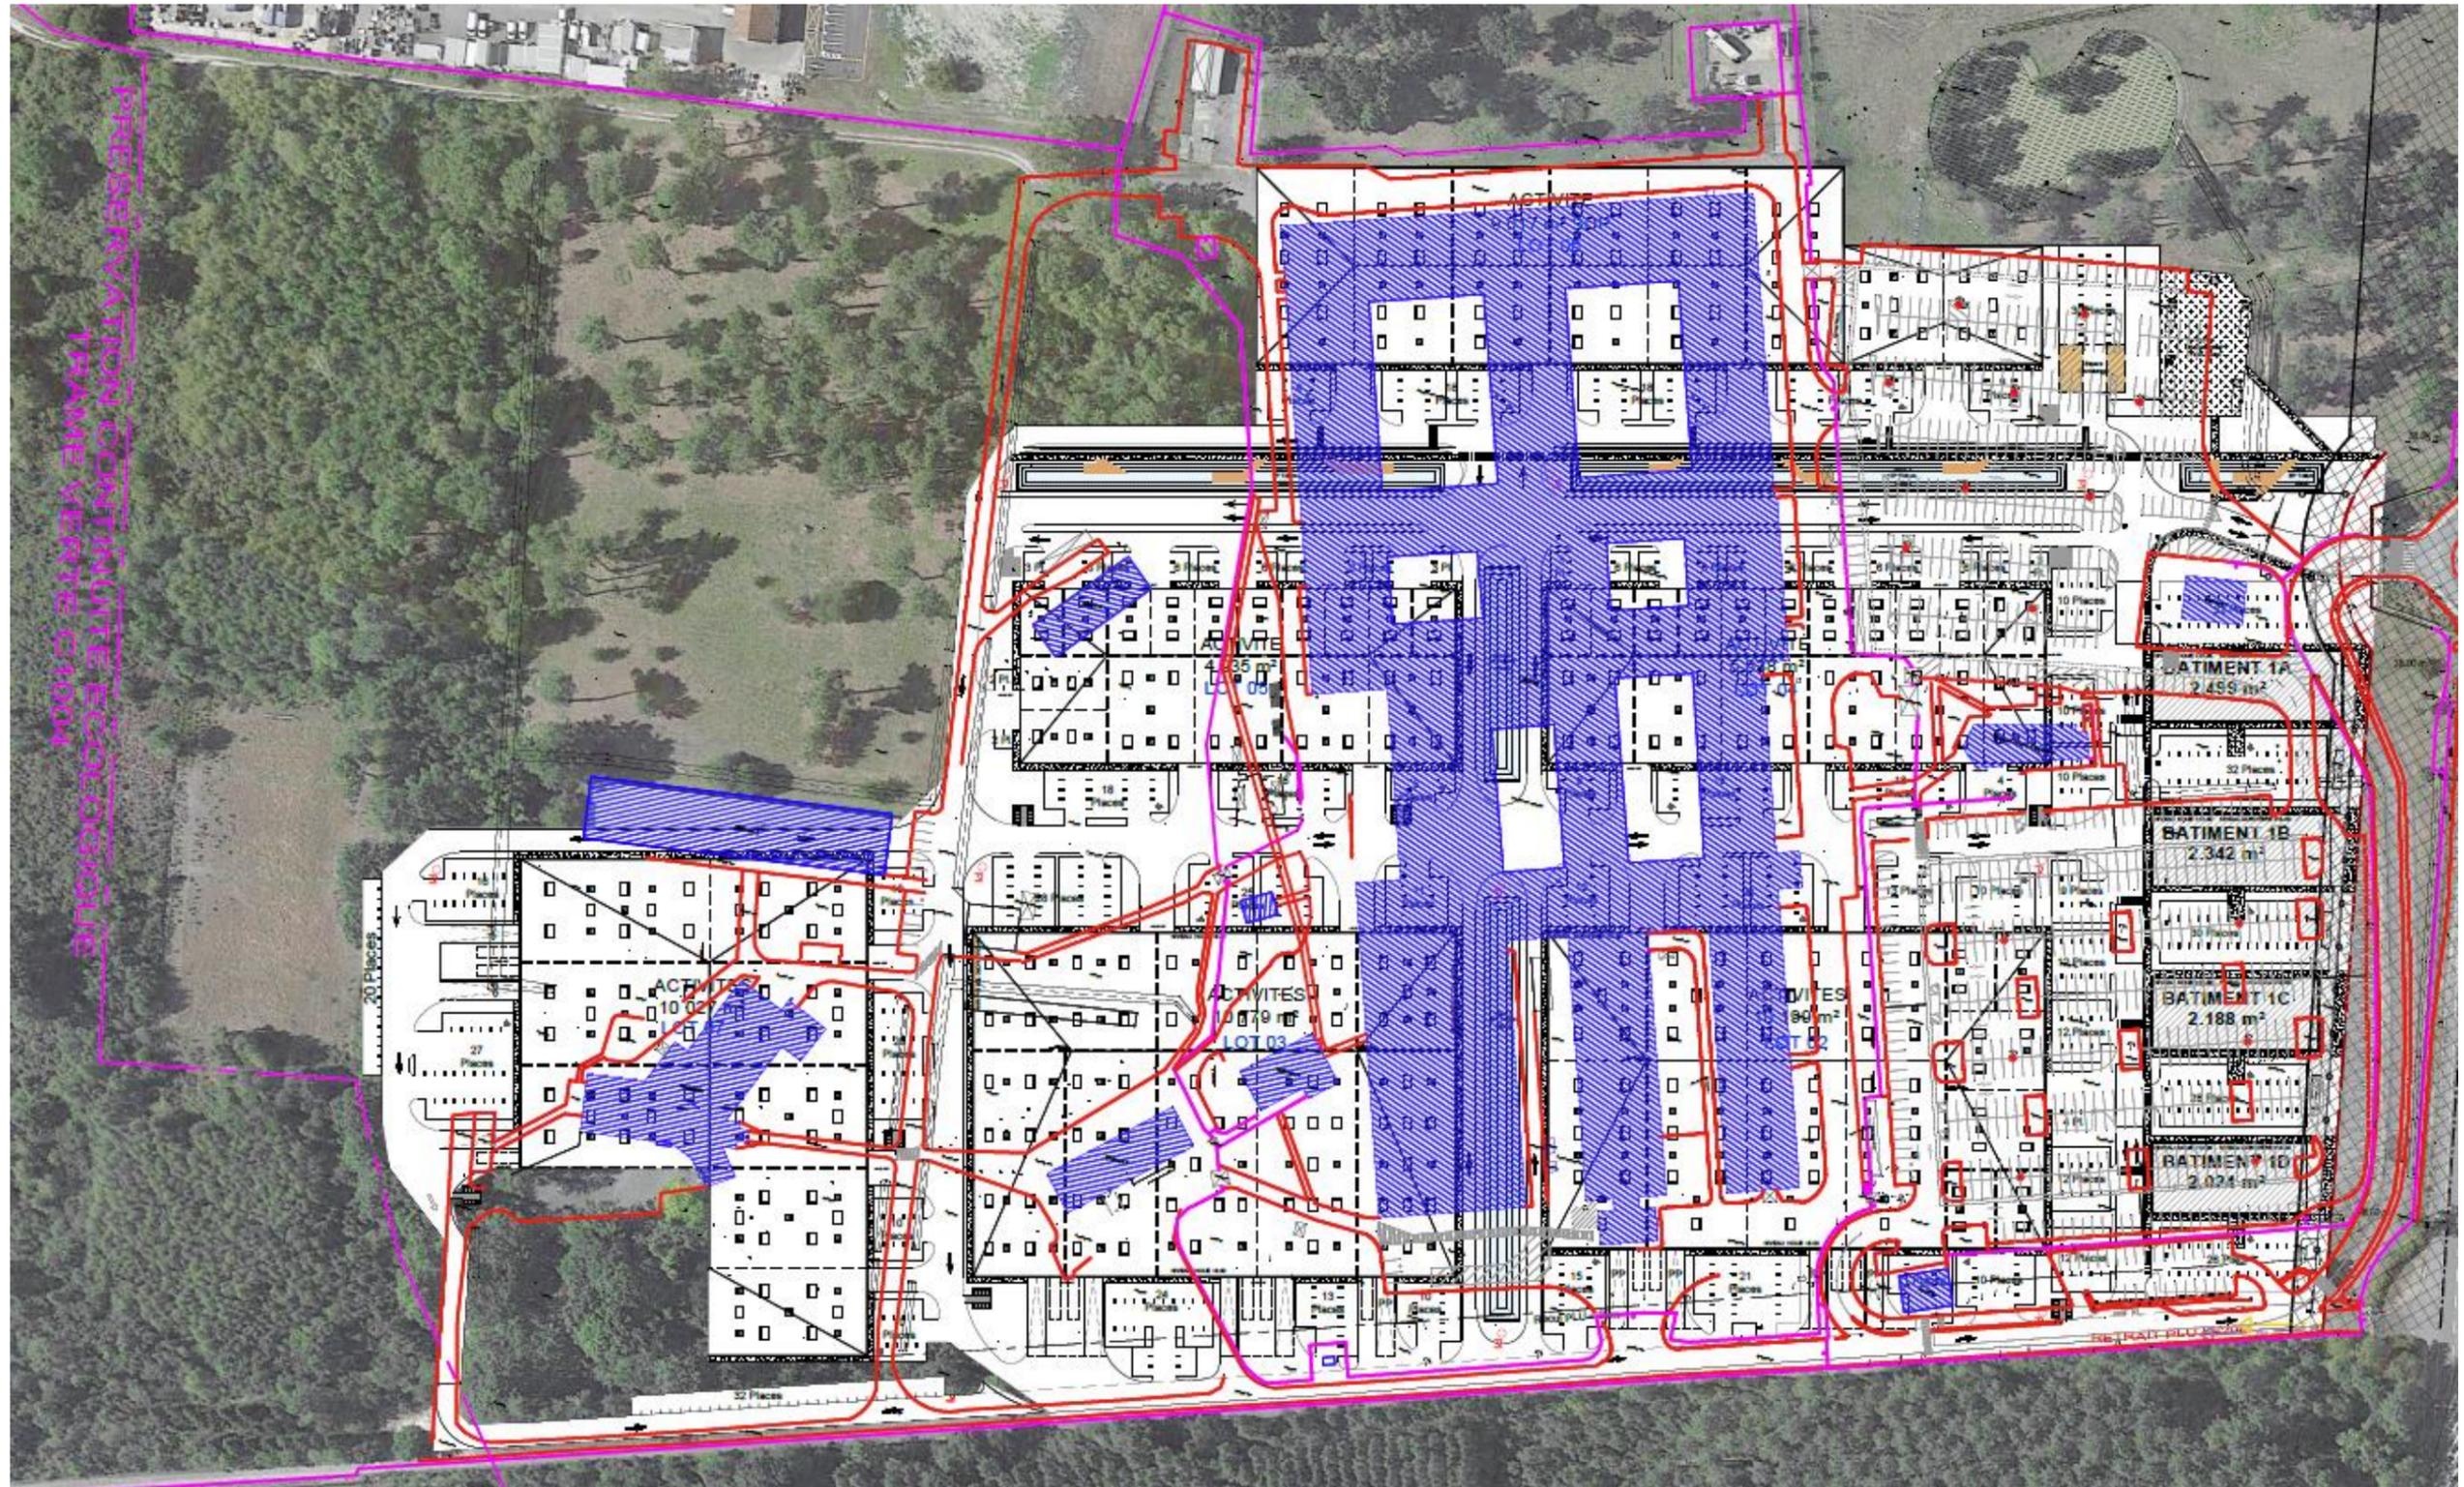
Zoom sur le plan masse du projet avec les bâtiments existants (en bleu) et la voirie existante (en rouge) (Source : Agence Franc Architectes, 2019)
